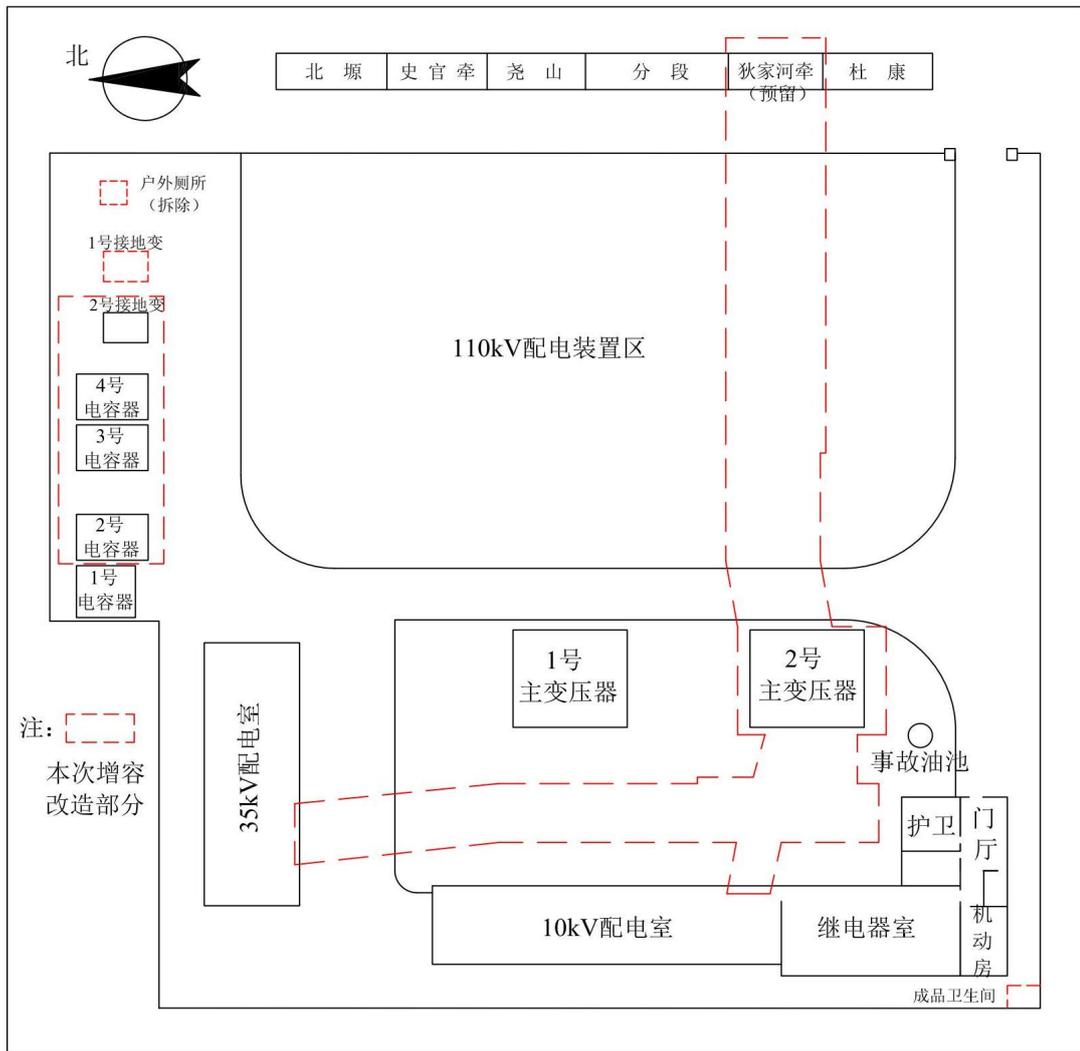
刘家卓 110kV 变电站总平面布置示意图
